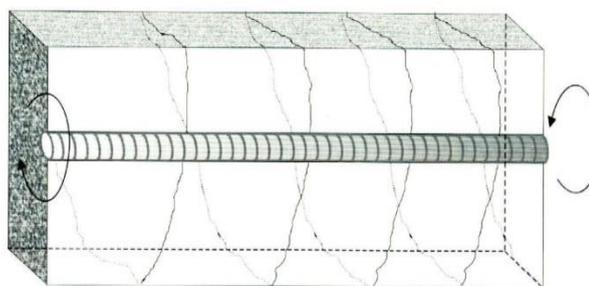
31 PATRÓN DE LAS GRIETAS POR TORSIÓN EN UNA VIGA PRISMÁTICA
